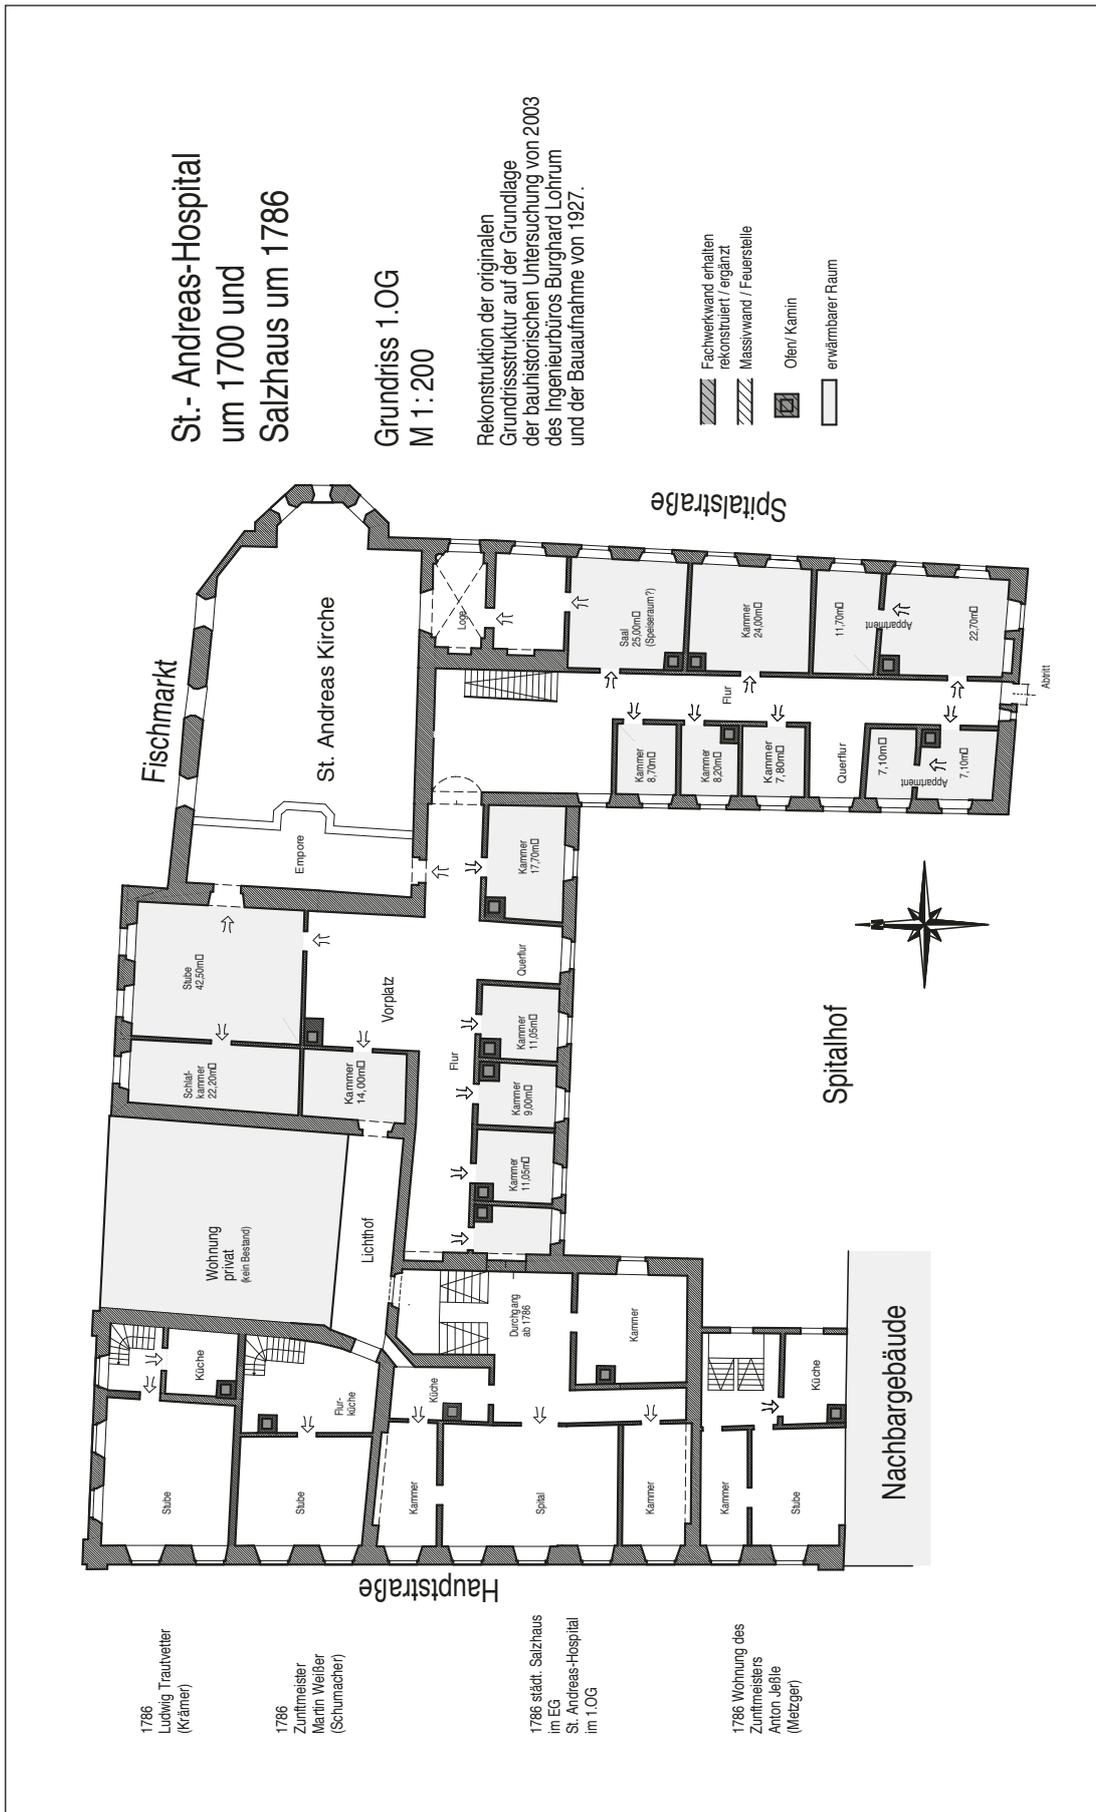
Offenburg, St.-Andreas-Spital, Grundriss 1. Obergeschoss. Rekonstruktion der Grundrisgliederung und Nutzungsstruktur um 1700.
